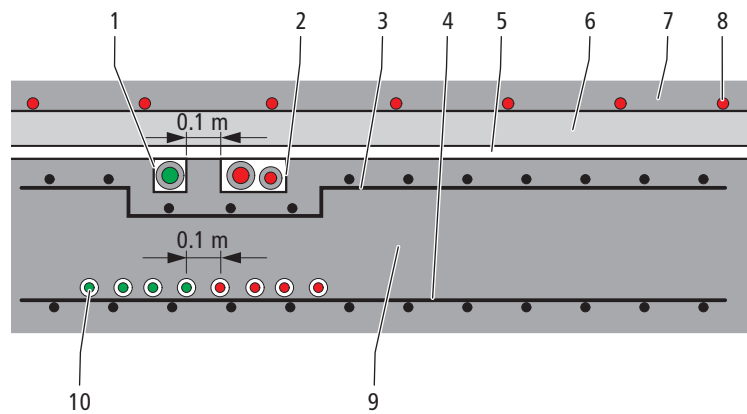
Sezione della struttura del pavimento (in conformità a W3/C3:2020, All. 7, fig. 20).
